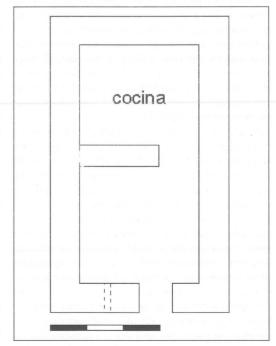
Planta de casa ss. XII-XIII reconstrucción hipotética
